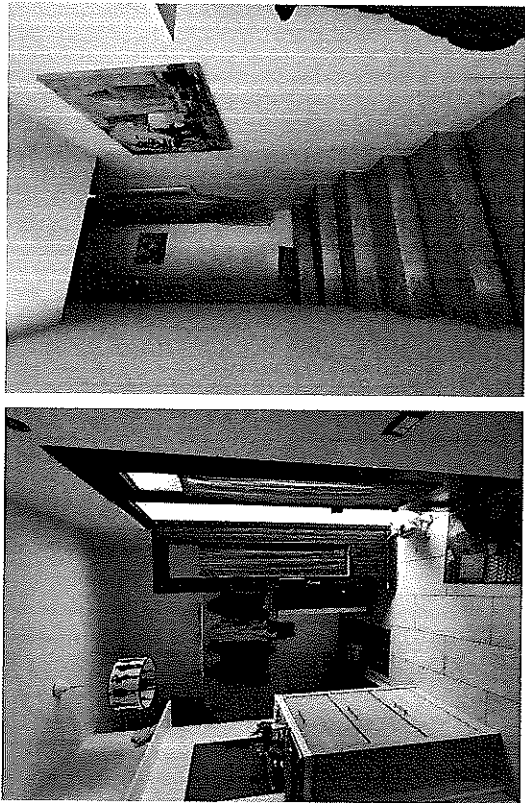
7: dettaglio ingresso al piano terra e scale per l'accesso al piano primo.
